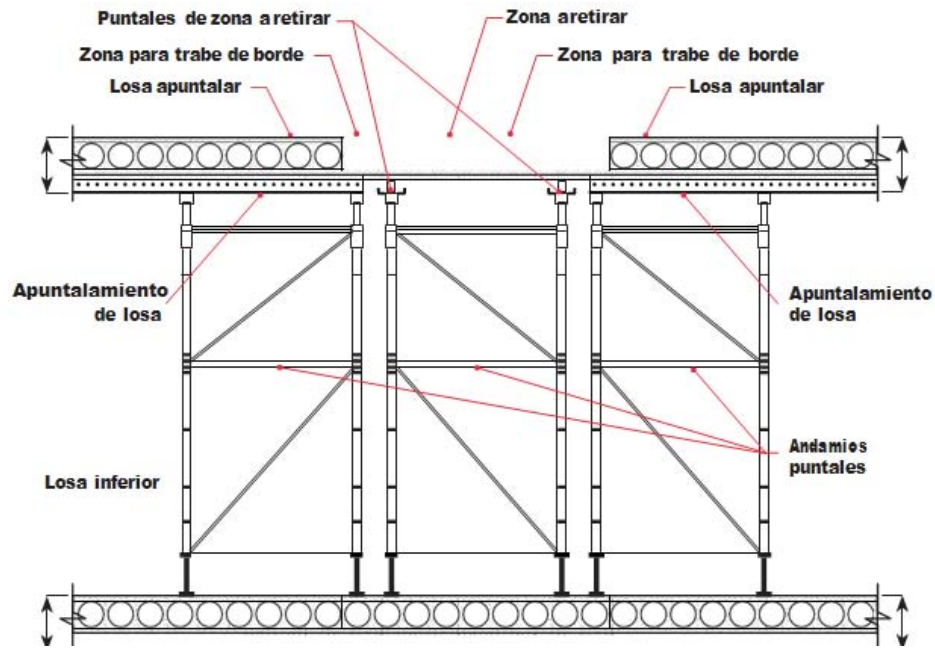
Apuntalamiento correcto para un corte en losa
